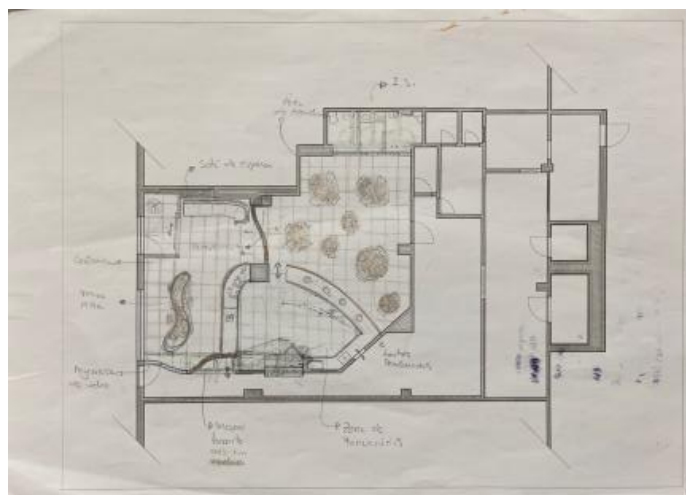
Planta de estudo 7. Fonte: Autora, 2025
